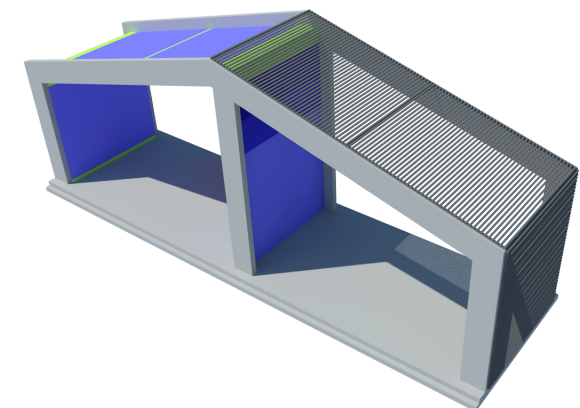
| Wandversatz (First) mit stabilisierenden Fassadenelement
